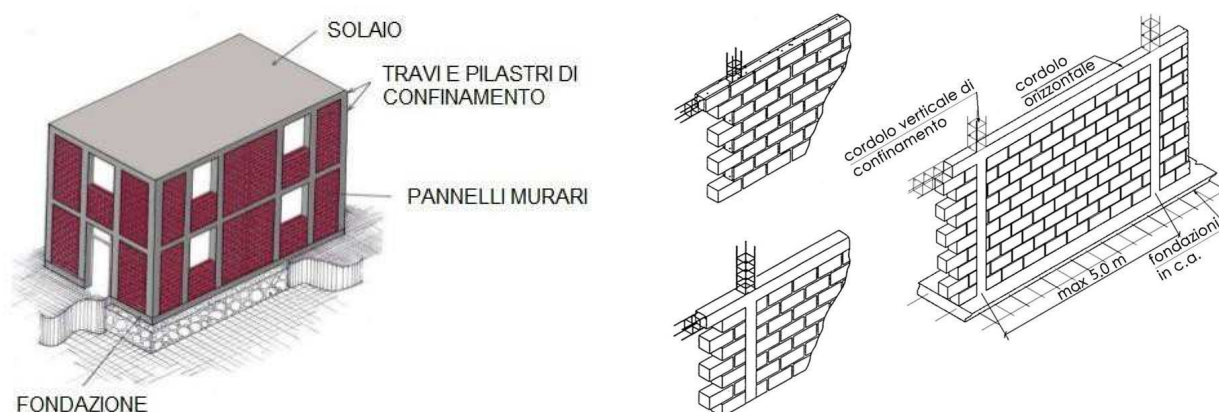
Edificio in muratura confinata: (a) struttura d'insieme e b) dettagli costruttivi.
